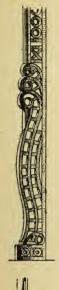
Élévation et plan d'une colonne en treillage du pavillon central (musée centennal des Fils et Tissus).
